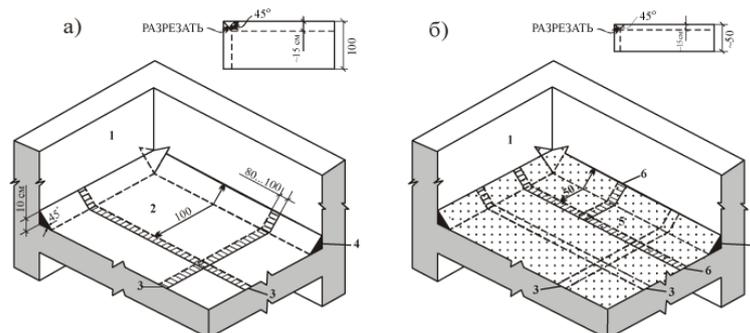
Розкладка та розкрій Акваізолу (а - нижнього шару, б - верхнього) при влаштуванні основного покрівельного килима в кутку парпету
